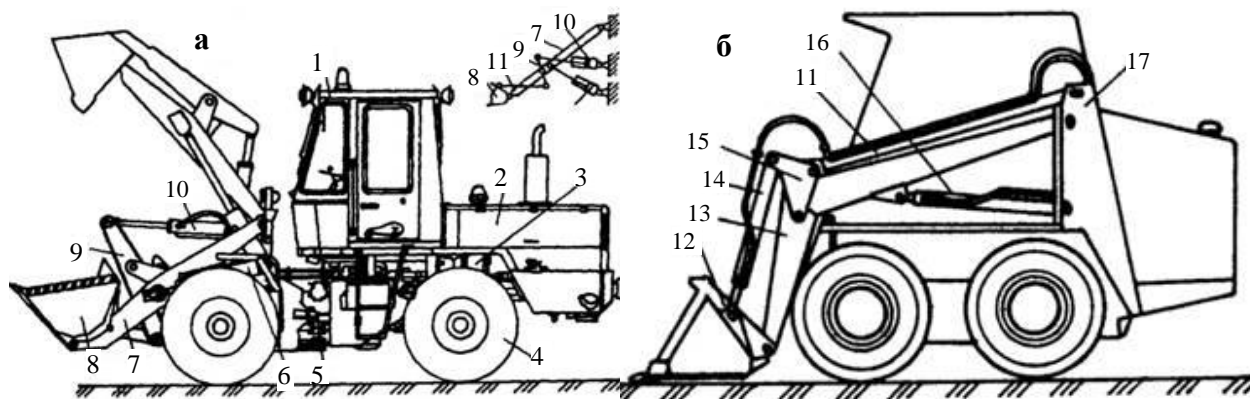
Схеми навантажувачів: а – фронтальний; б – малогабаритний універсальний;
